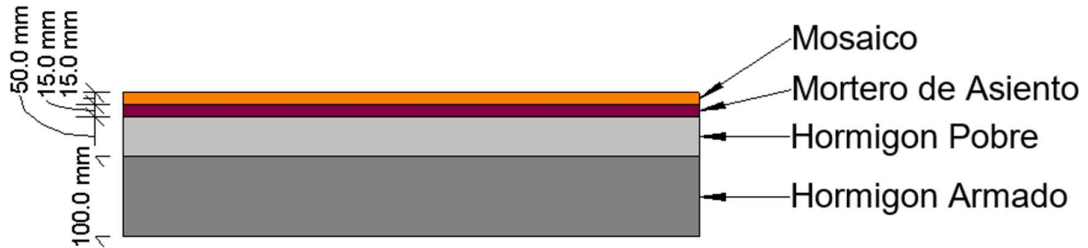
Esquema de corte cerramiento horizontal Tipo 5
